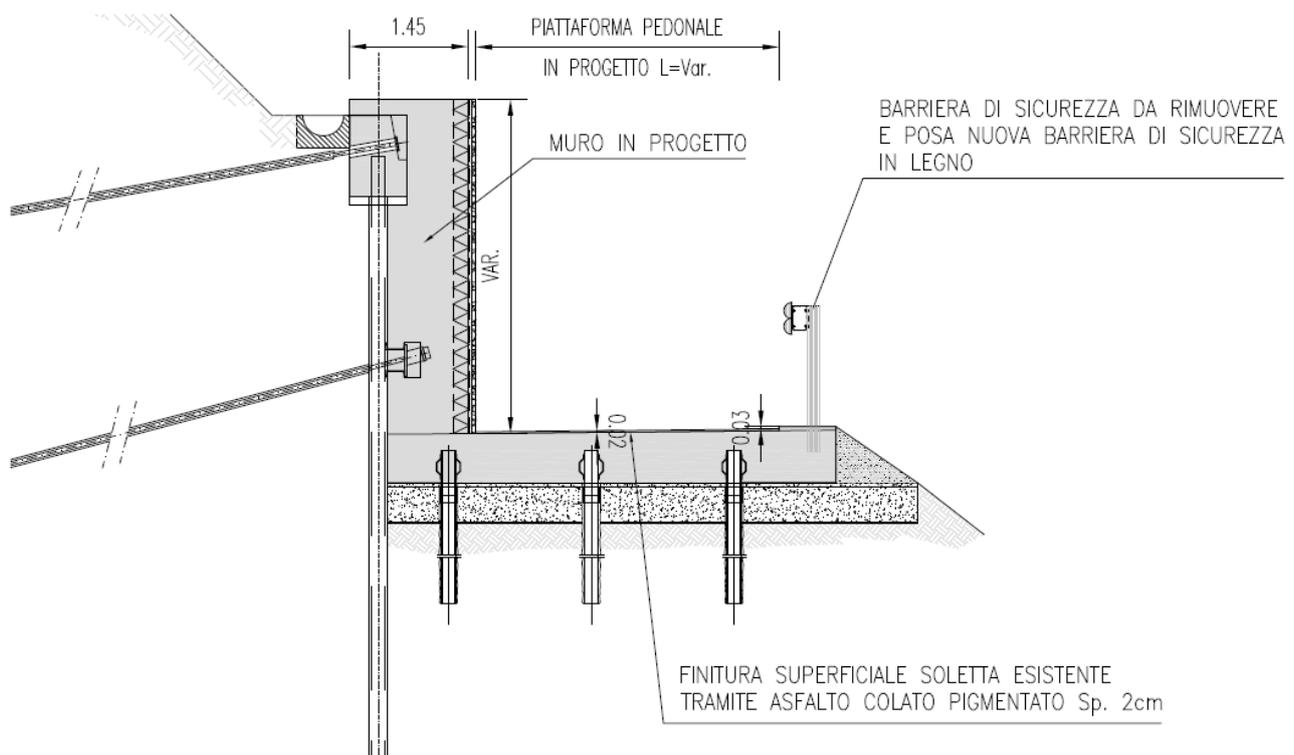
Particolare pacchetto di pavimentazione su soletta esistente
